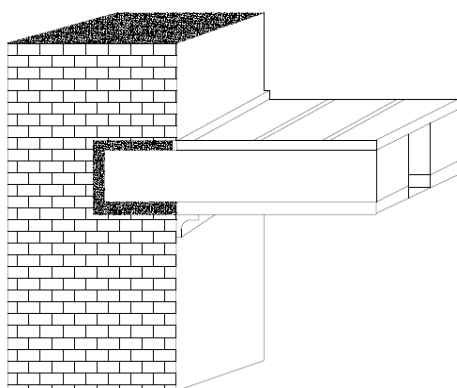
Esquema de apoio de viga de madeira ao pano de alvenaria de pedra (fração C)
